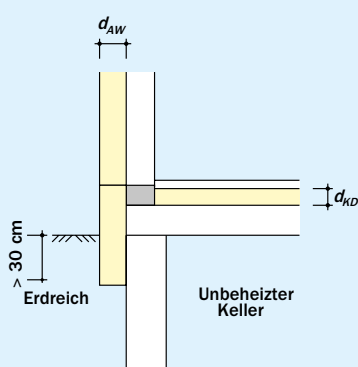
Konstruktionszeichnung aus KS-Detailsammlung, Detail 2.2.3
